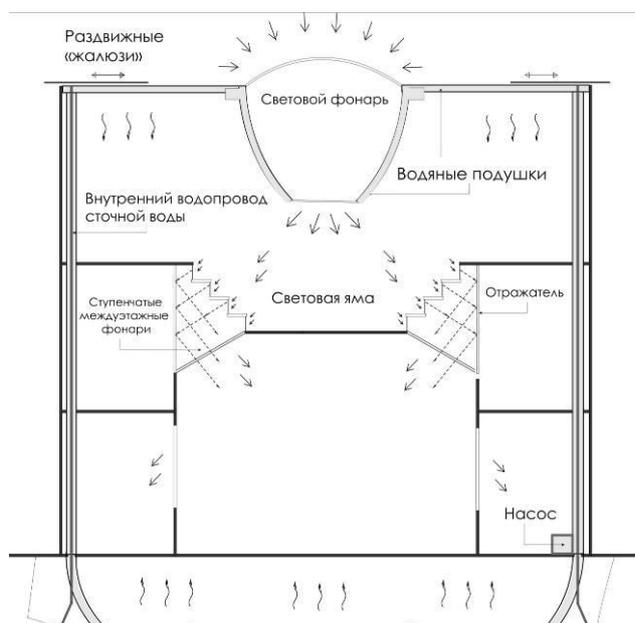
Схема освещения, отопления и кондиционирования в здании.
